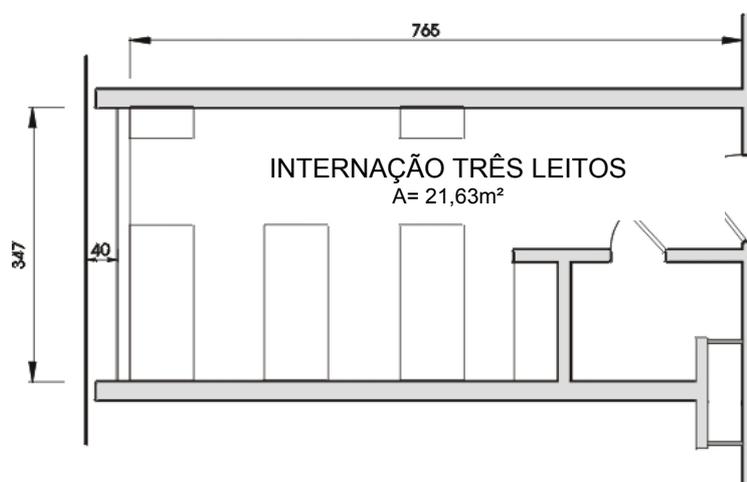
Planta baixa do quarto de internação com três leitos
